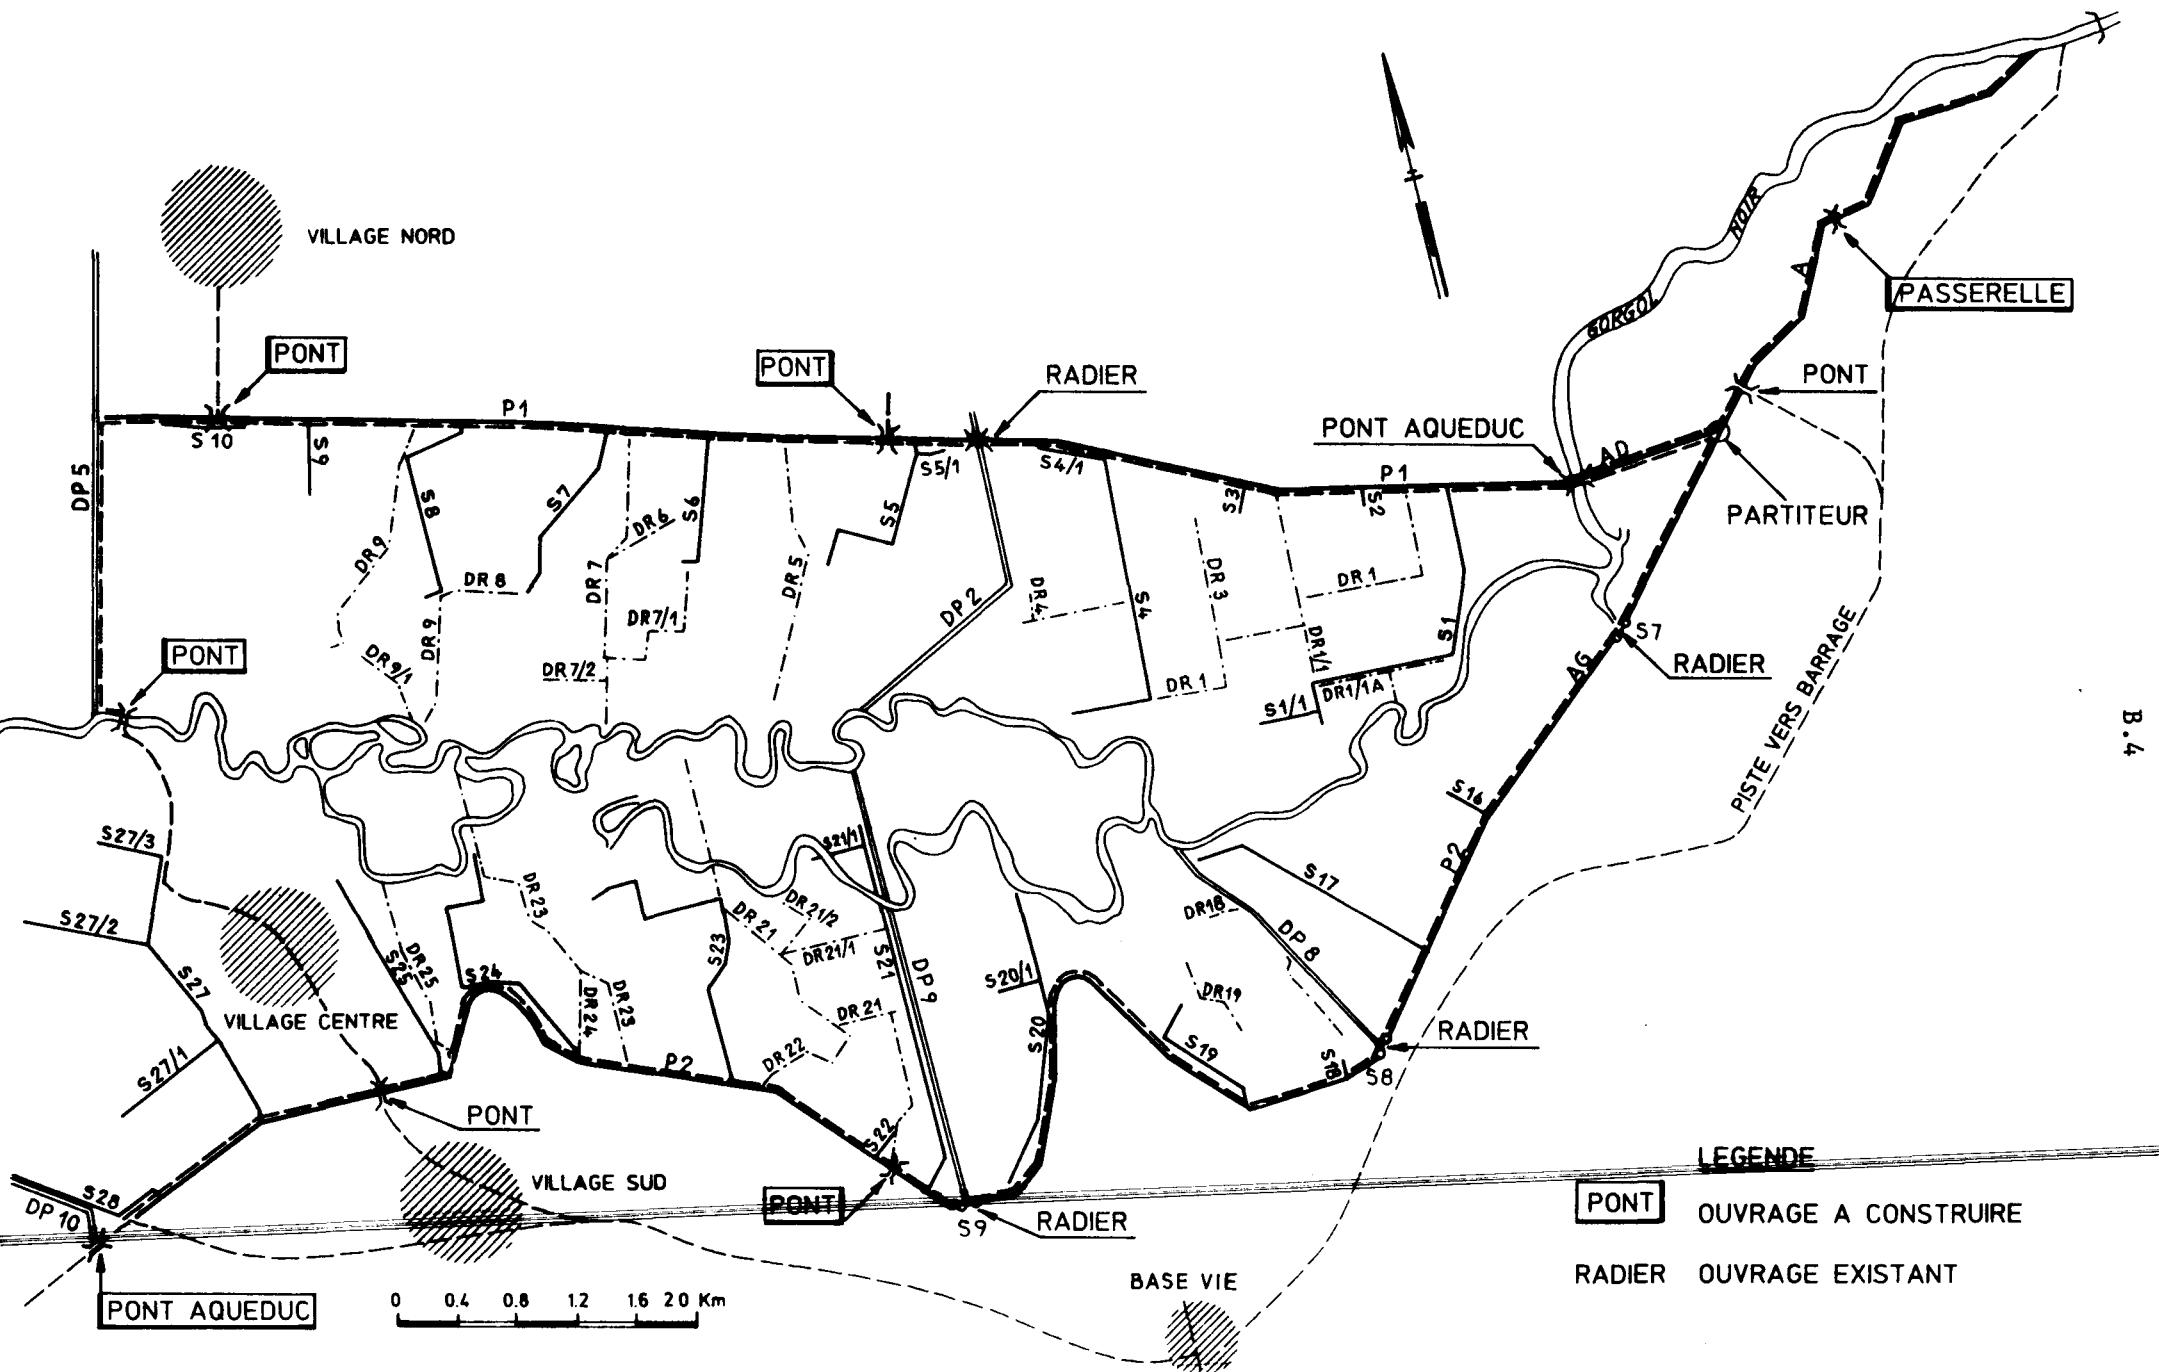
PISTES ET OUVRAGES ANNEXES A L'INTERIEUR DU PERIMETRE; OUVRAGES A CONSTRUIRE
